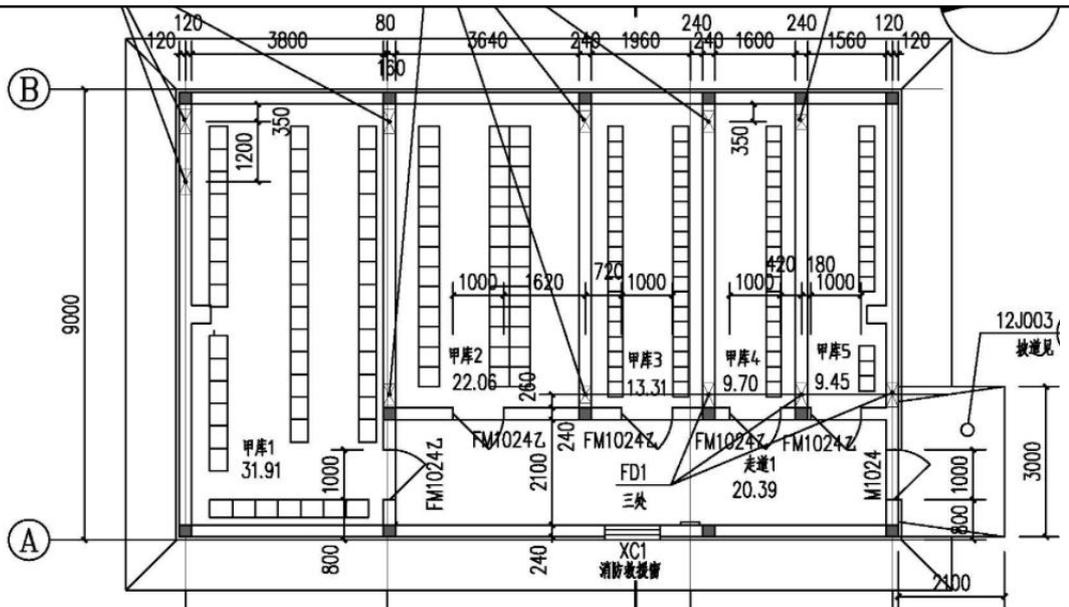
21-甲库甲类危险化学品暂存库平面布置图
